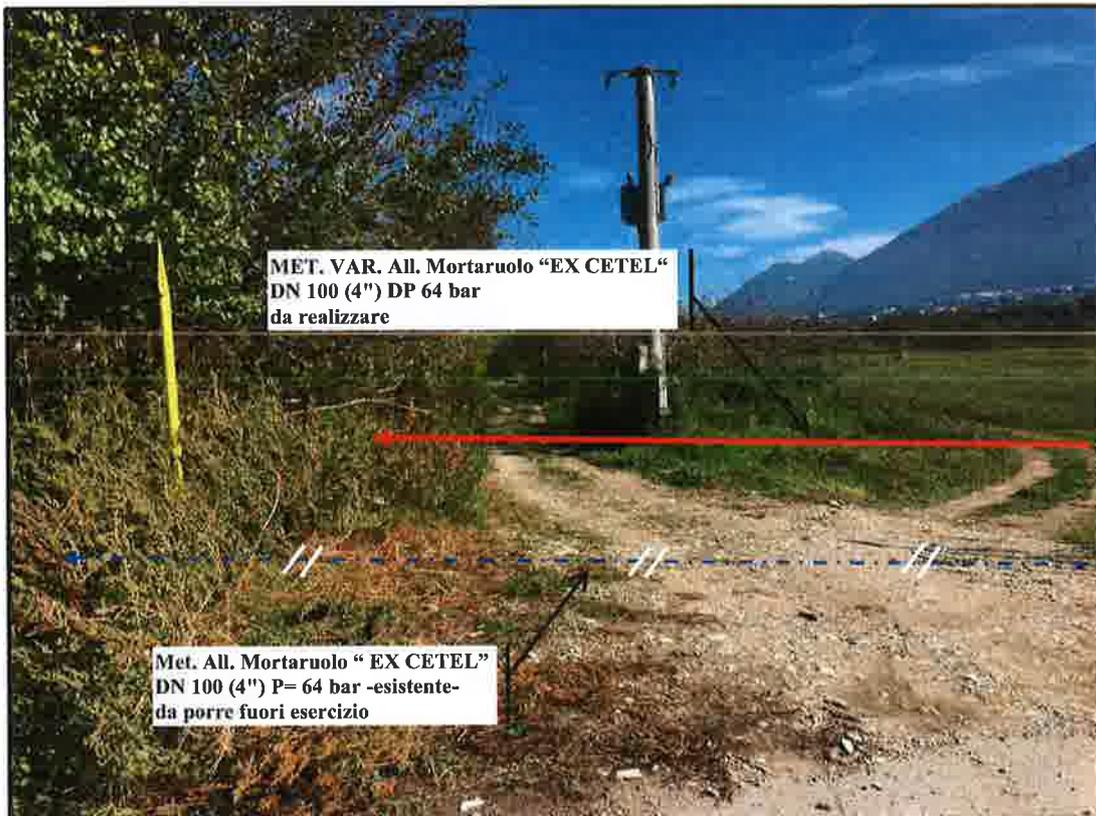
Vista variante metanodotto da realizzare e attraversamento stradina in terra
